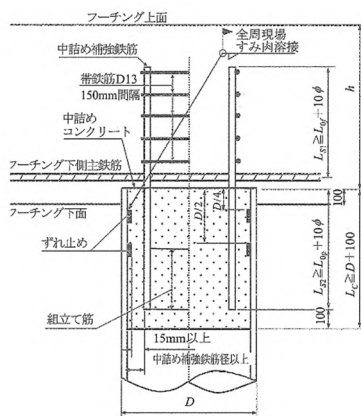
鋼管杭の接合方法 図 6.5.18 鋼管ソイルセメント杭の接合方法
